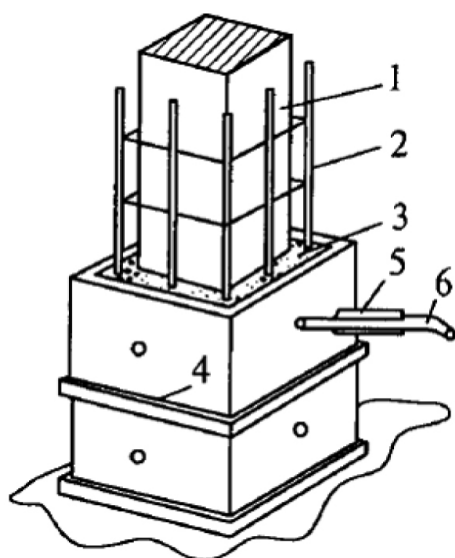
Схема підсилення колони залізобетонною обоймою:
